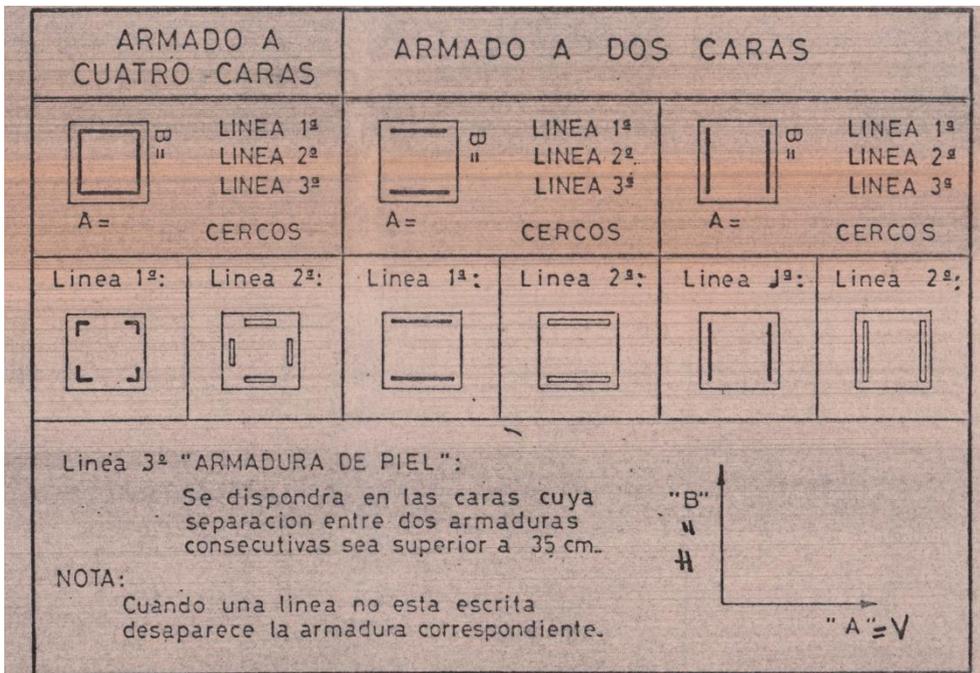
Cuadro de armados. Plano Cuadro de Pilares. Fuente: Archivo personal de Cortés.
